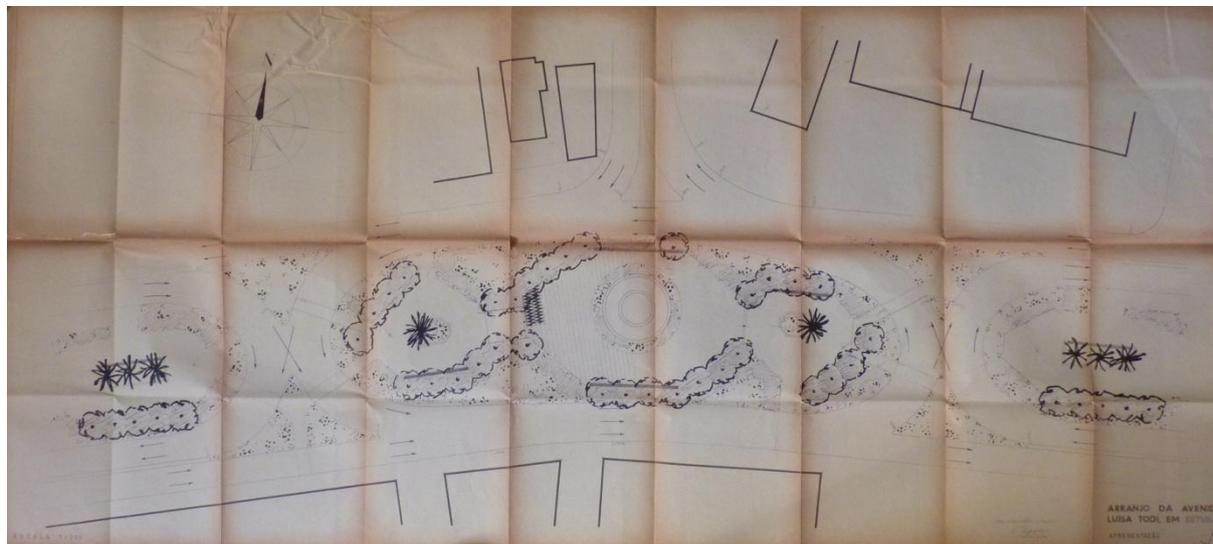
Arranjo da Avenida Luísa Todi: Planta de apresentação, em Setúbal. 1970.
